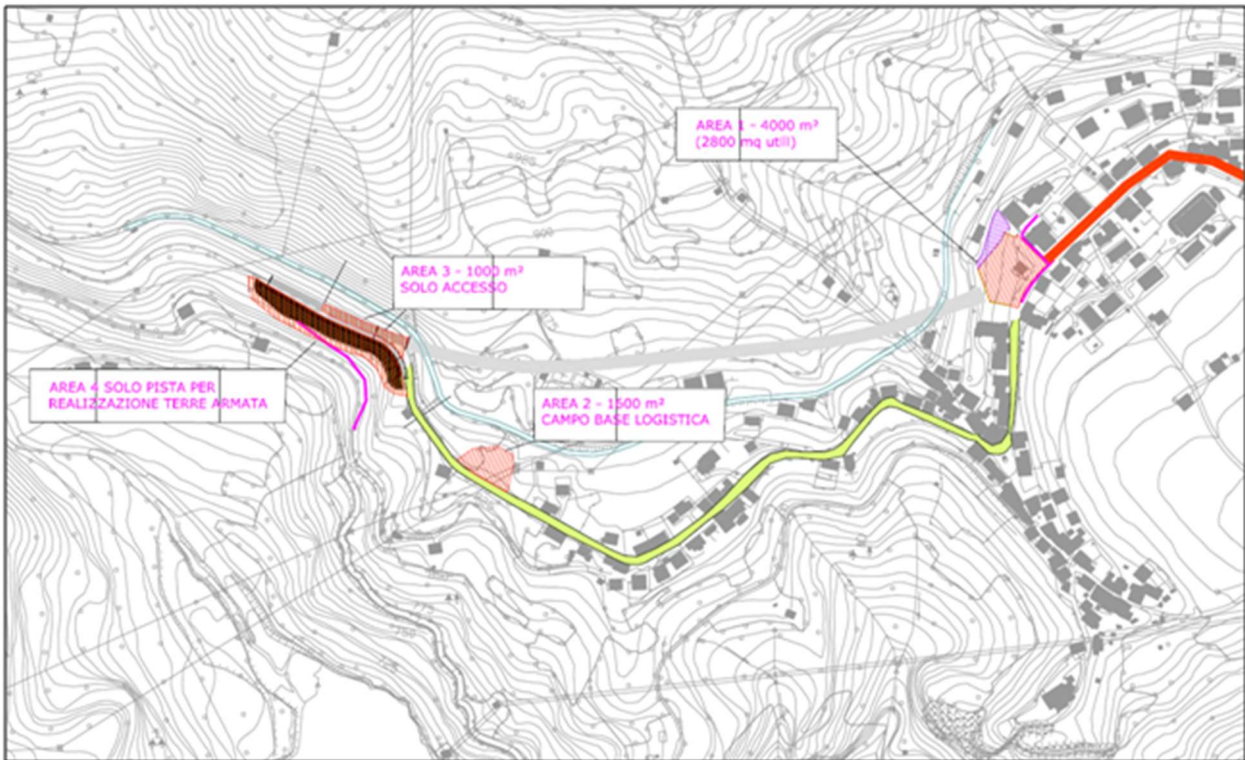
Localizzazione delle quattro aree di cantiere ((Fonte: elaborato di progetto: 245_T00_CA01_CAN_CO01_A)
